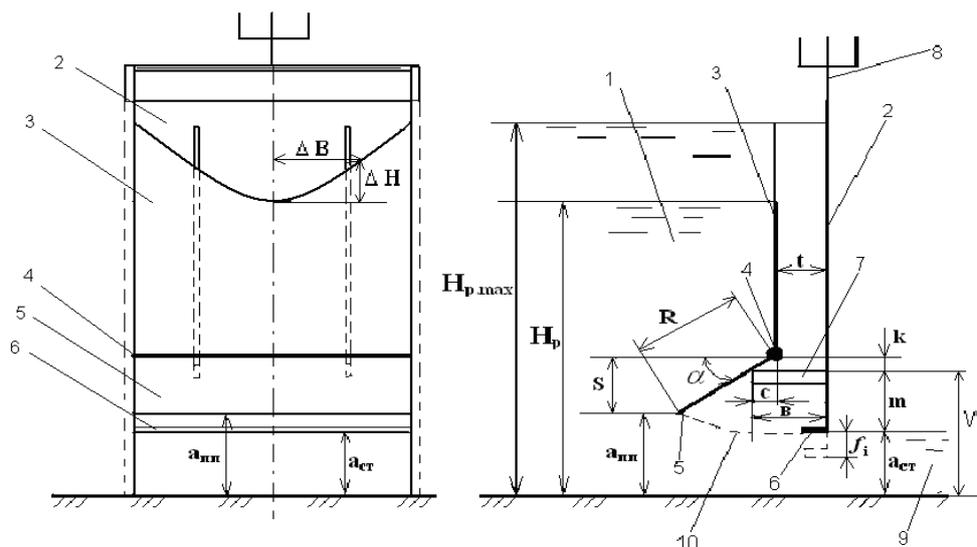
Расчетная схема СПКЗ: 1 – верхний бьеф; 2 – плоский затвор; 3 – передняя стенка; 4 – шарнир; 5 – поворотная пластина; 6 – горизонтальный козырек; 7 – штанга взаимодействия; 8 – подъемный винт затвора; 9 – нижний бьеф; 10 – траектория сжатия струи; 11 – траектория смещения нижней грани затвора при регулировании.
